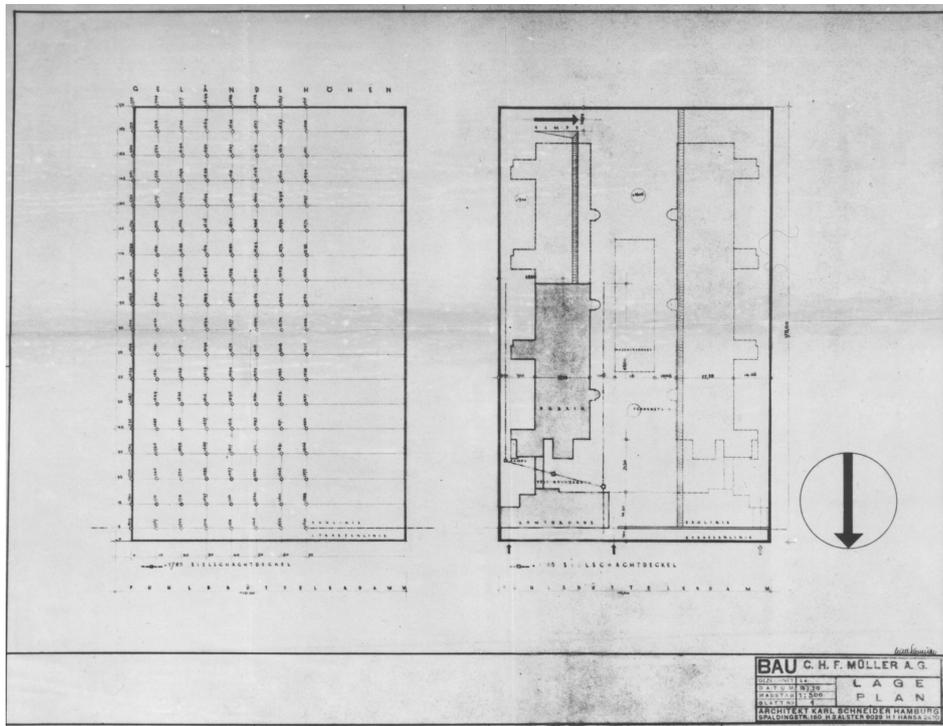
Geländehöhen u. Lageplan, 1. Bauabschnitt dunkel gekennz., 15. Juli 1929
